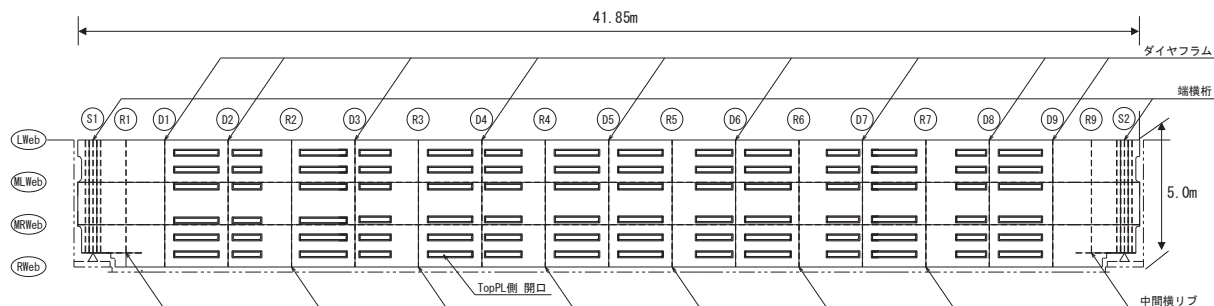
(2) 鋼製遮水壁（鋼桁 1） 平面図
